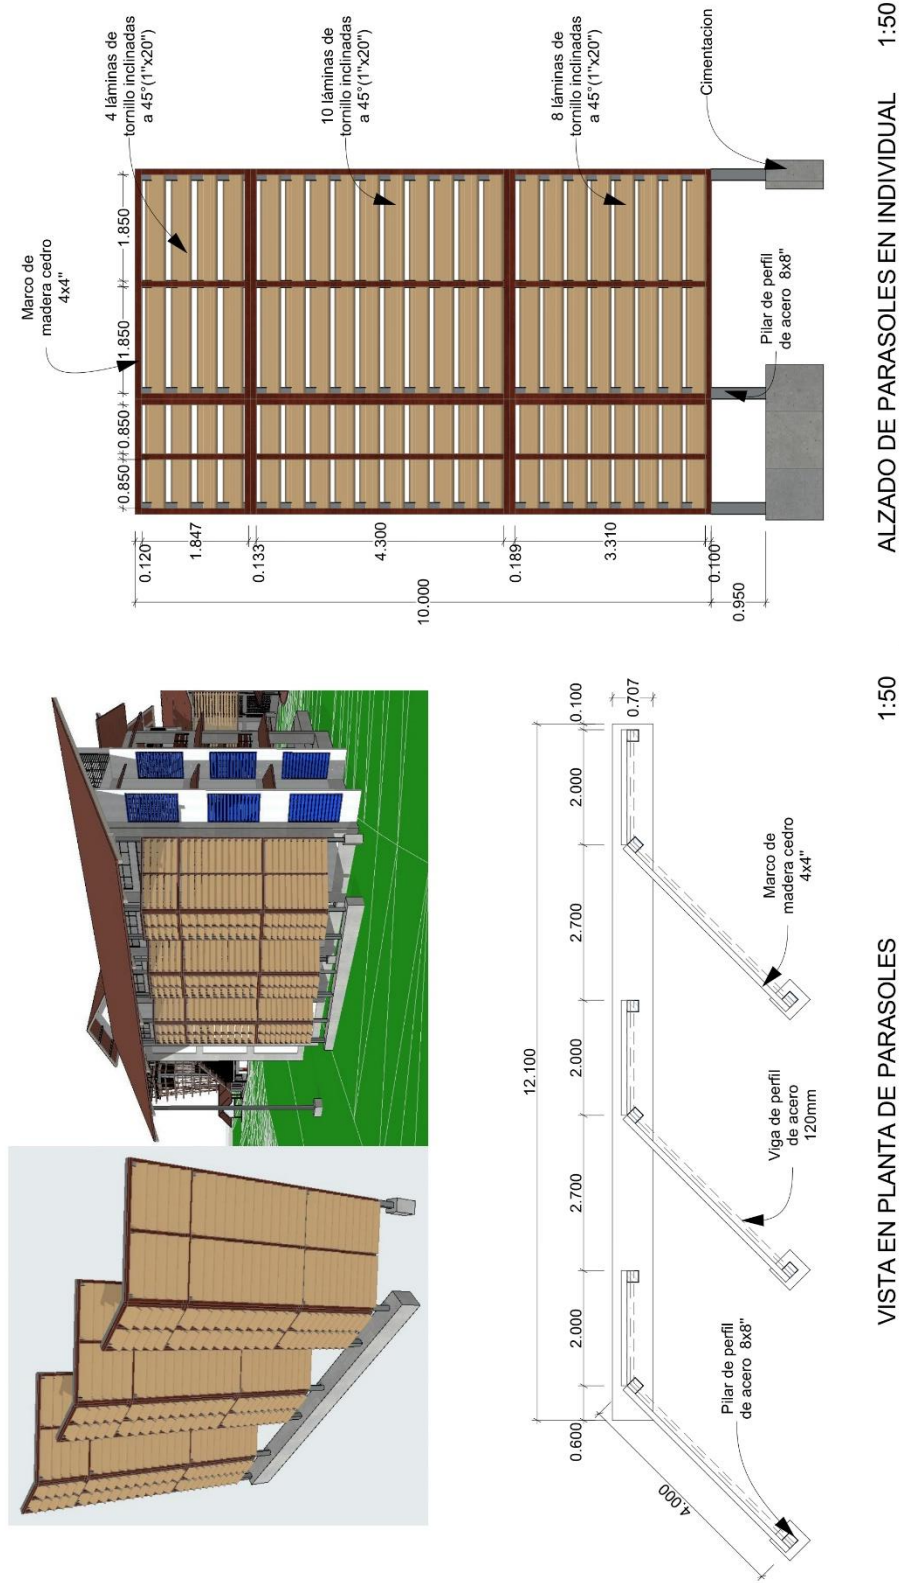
Parasol utilizado en la fachada del pabellón administrativo.
